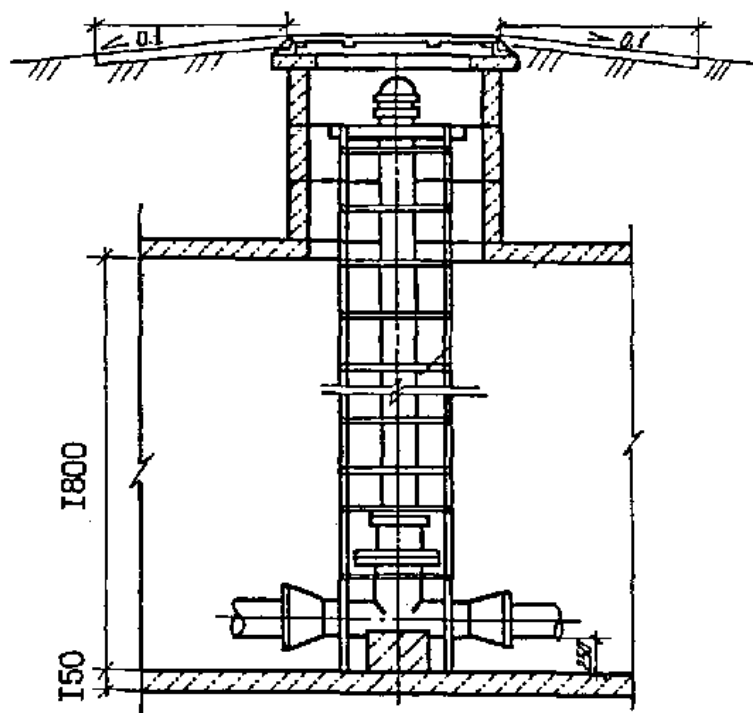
Схема установки пожарного гидранта на водопроводной сети
